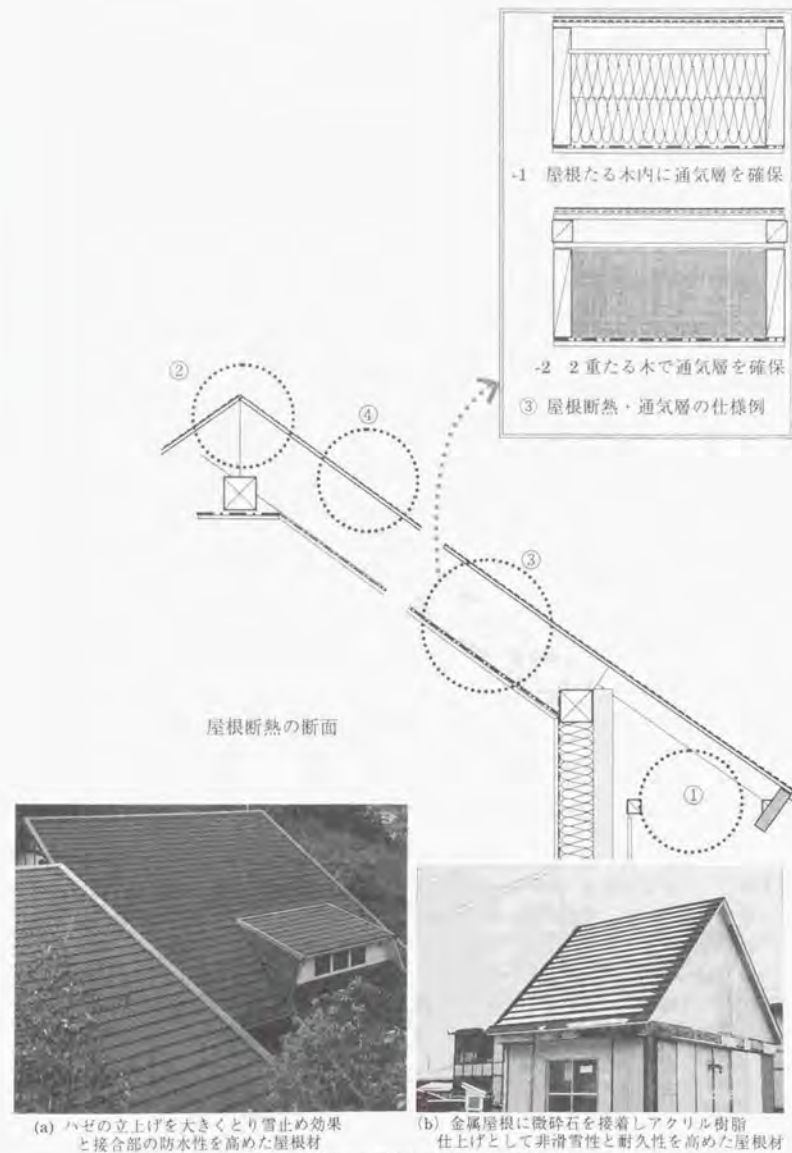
(図 12.2 中④) 非滑雪屋根材のバリエーション
